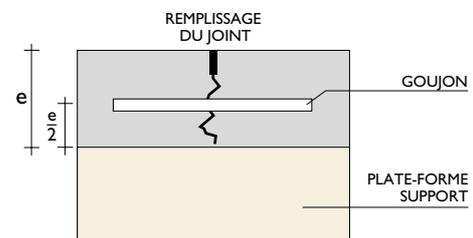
Schéma d'un joint de construction (transversal ou longitudinal)
